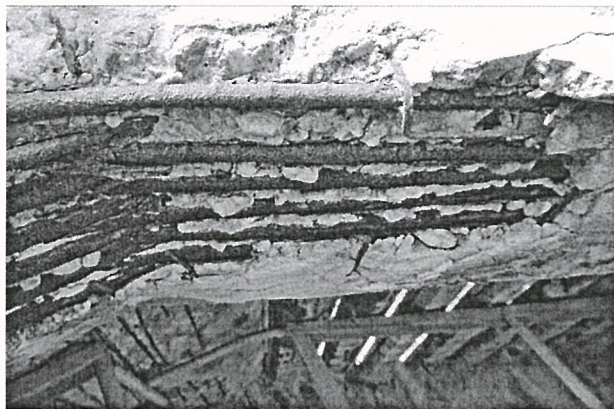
Otulina betonowa, która odpadła z belek nośnych
